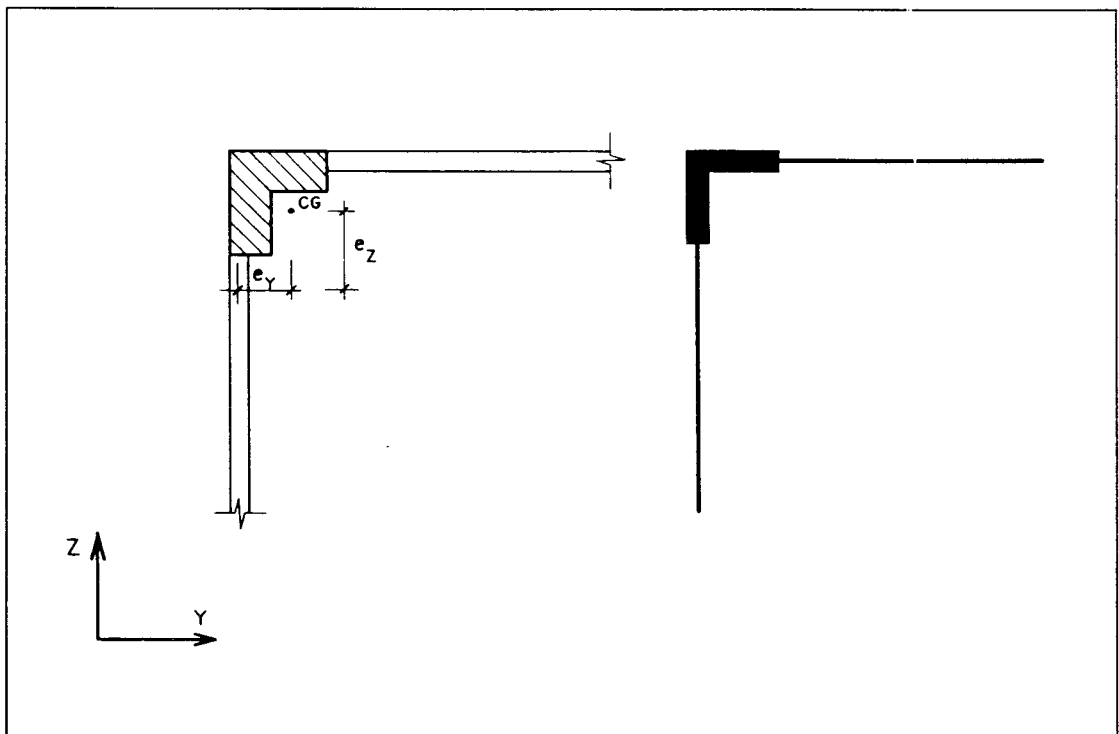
Excentricidades de um trecho de viga em relação ao pilar.
